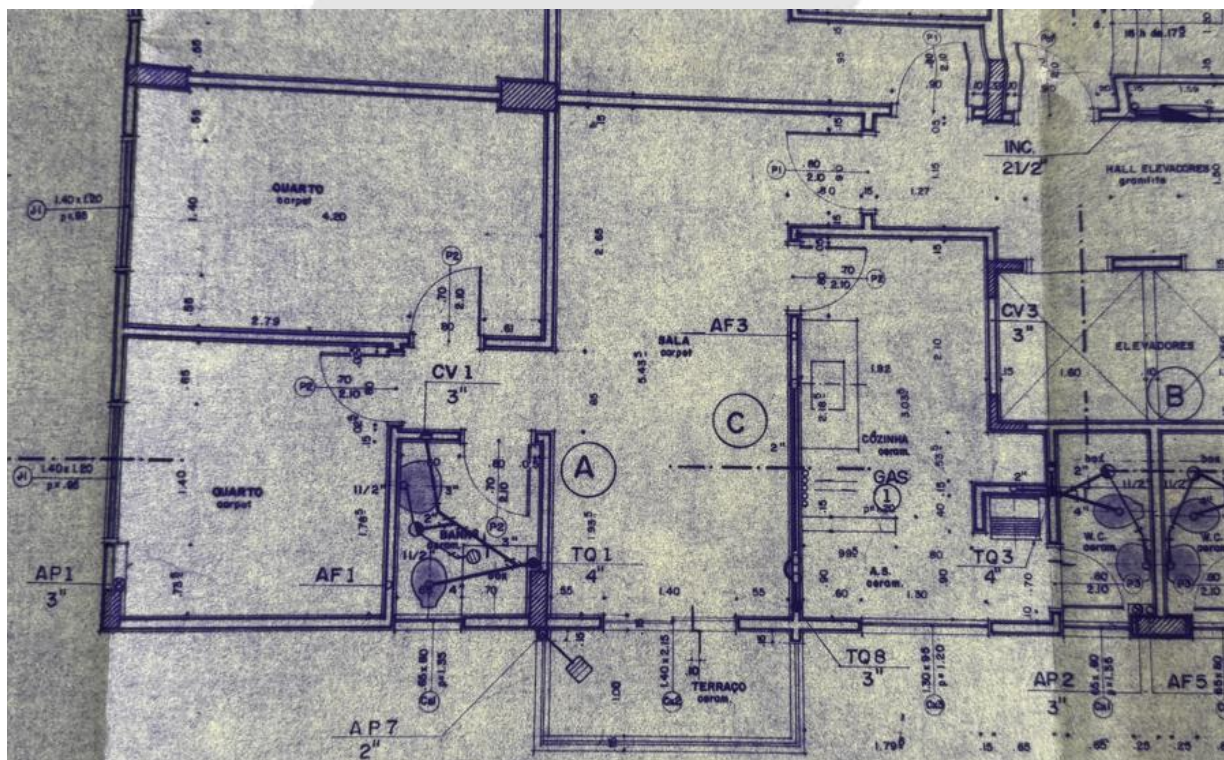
PROJETO DA UNIDADE IN LIDE FORNECIDA DURANTE DILIGÊNCIA DA FOLHA 003 NOMEADA COMO EXECUÇÃO DE ALVENARIA – ANDAR TIPO - PLANTA
